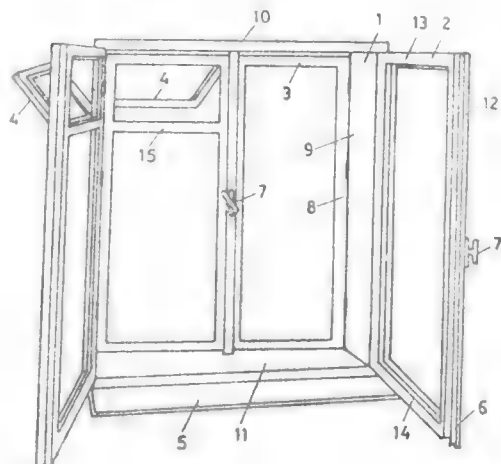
Construcția unei ferestre (fereastră dublă cu deschidere interioară, cu ochi de ventilație :
